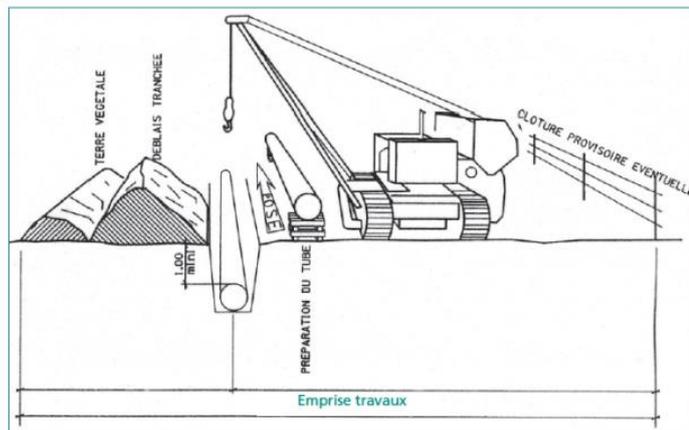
Schéma de la conduite d'un chantier de canalisation
